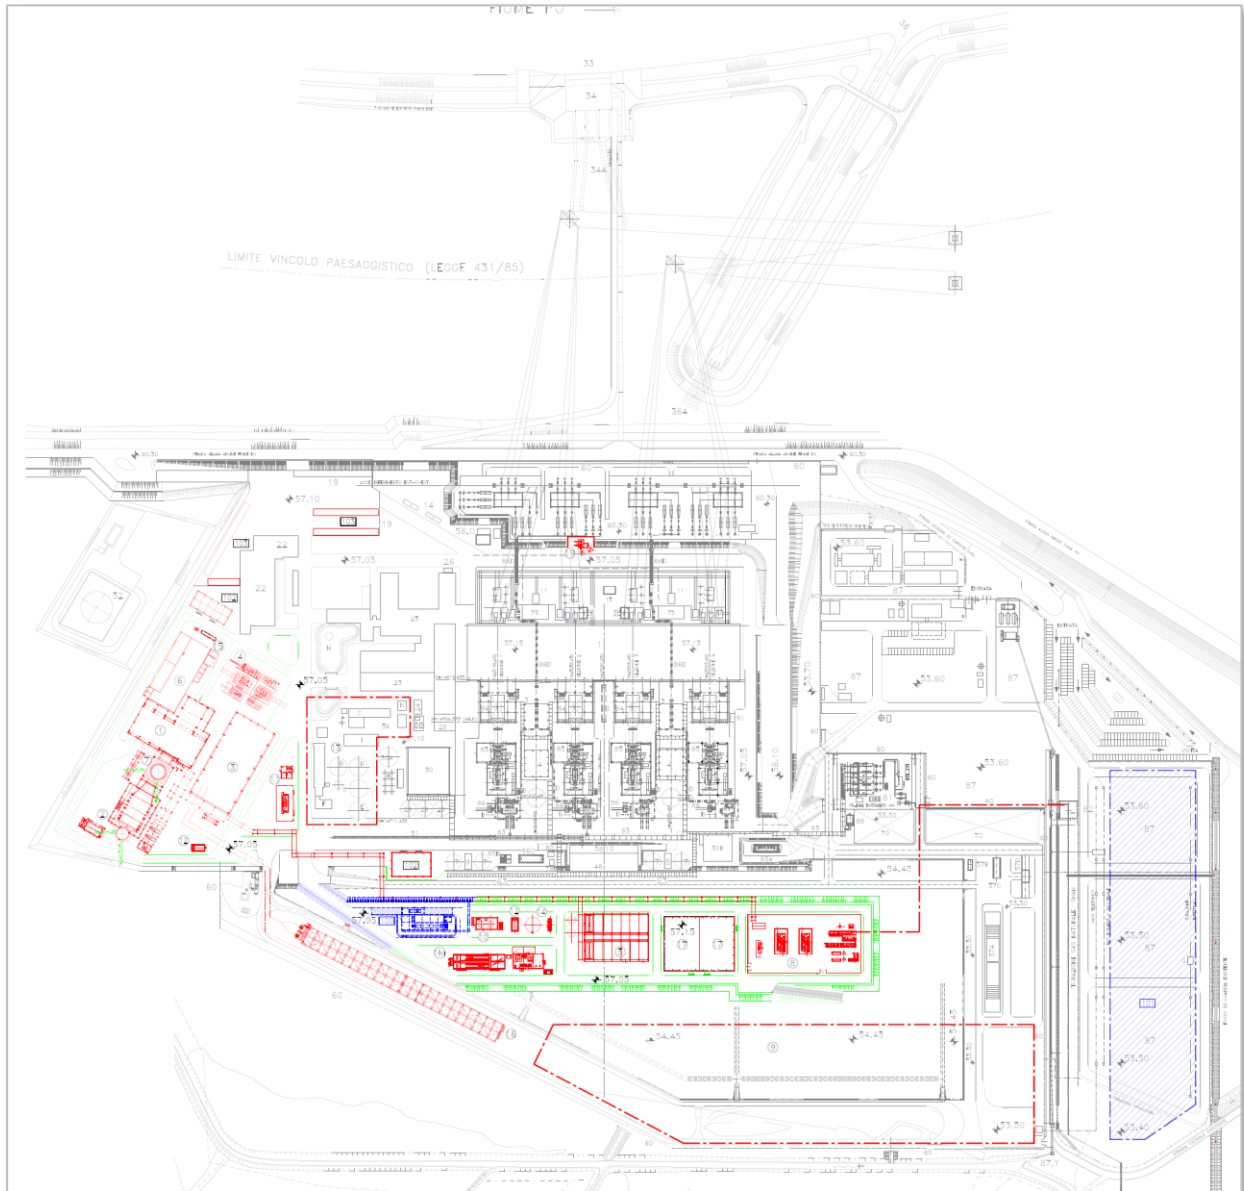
Planimetria della sistemazione delle nuove opere (in rosso)
